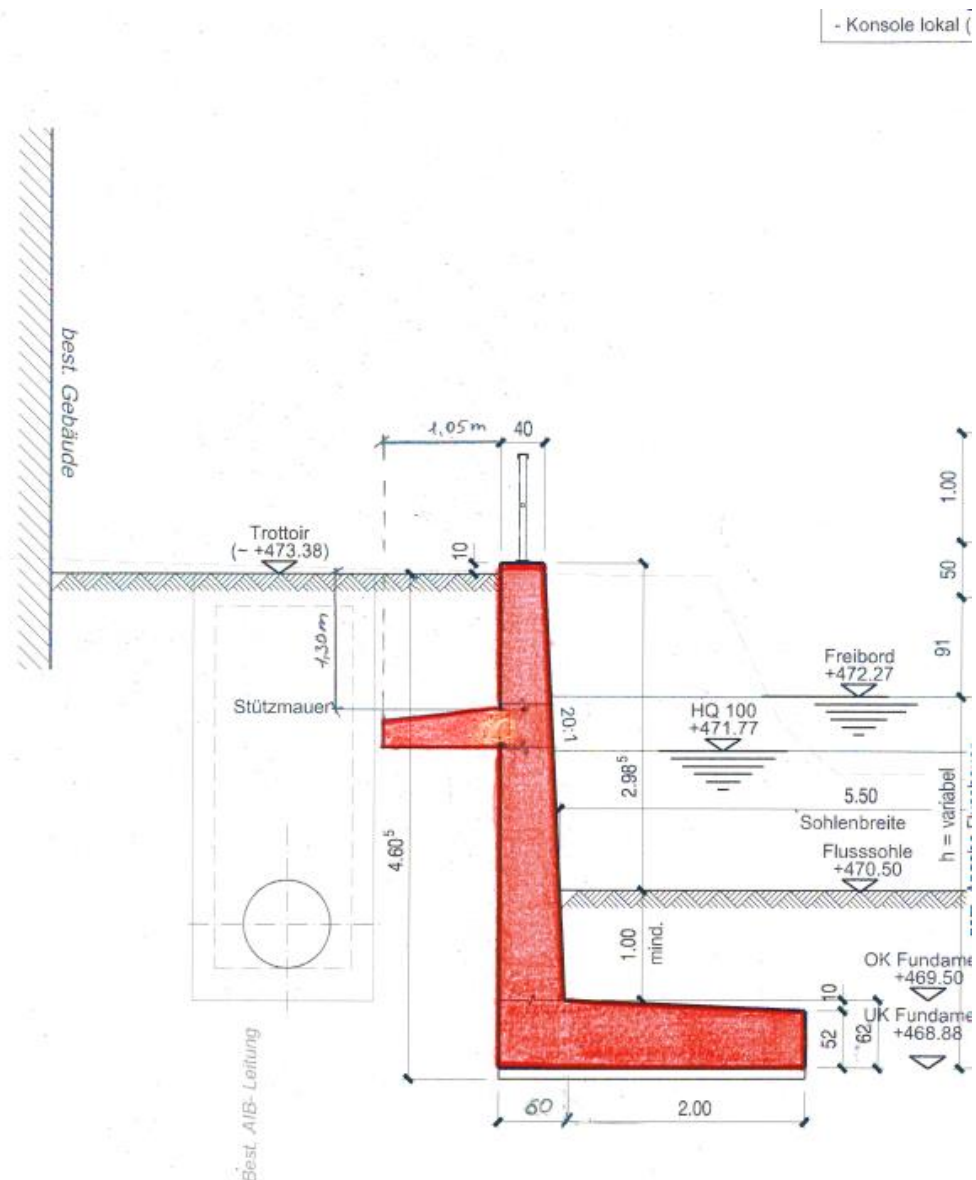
Skizze Grundlage für die Bemessung Stützmauer Seite Dorfgasse. Schnitt ca. bei km 11.100<sup>6</sup>
